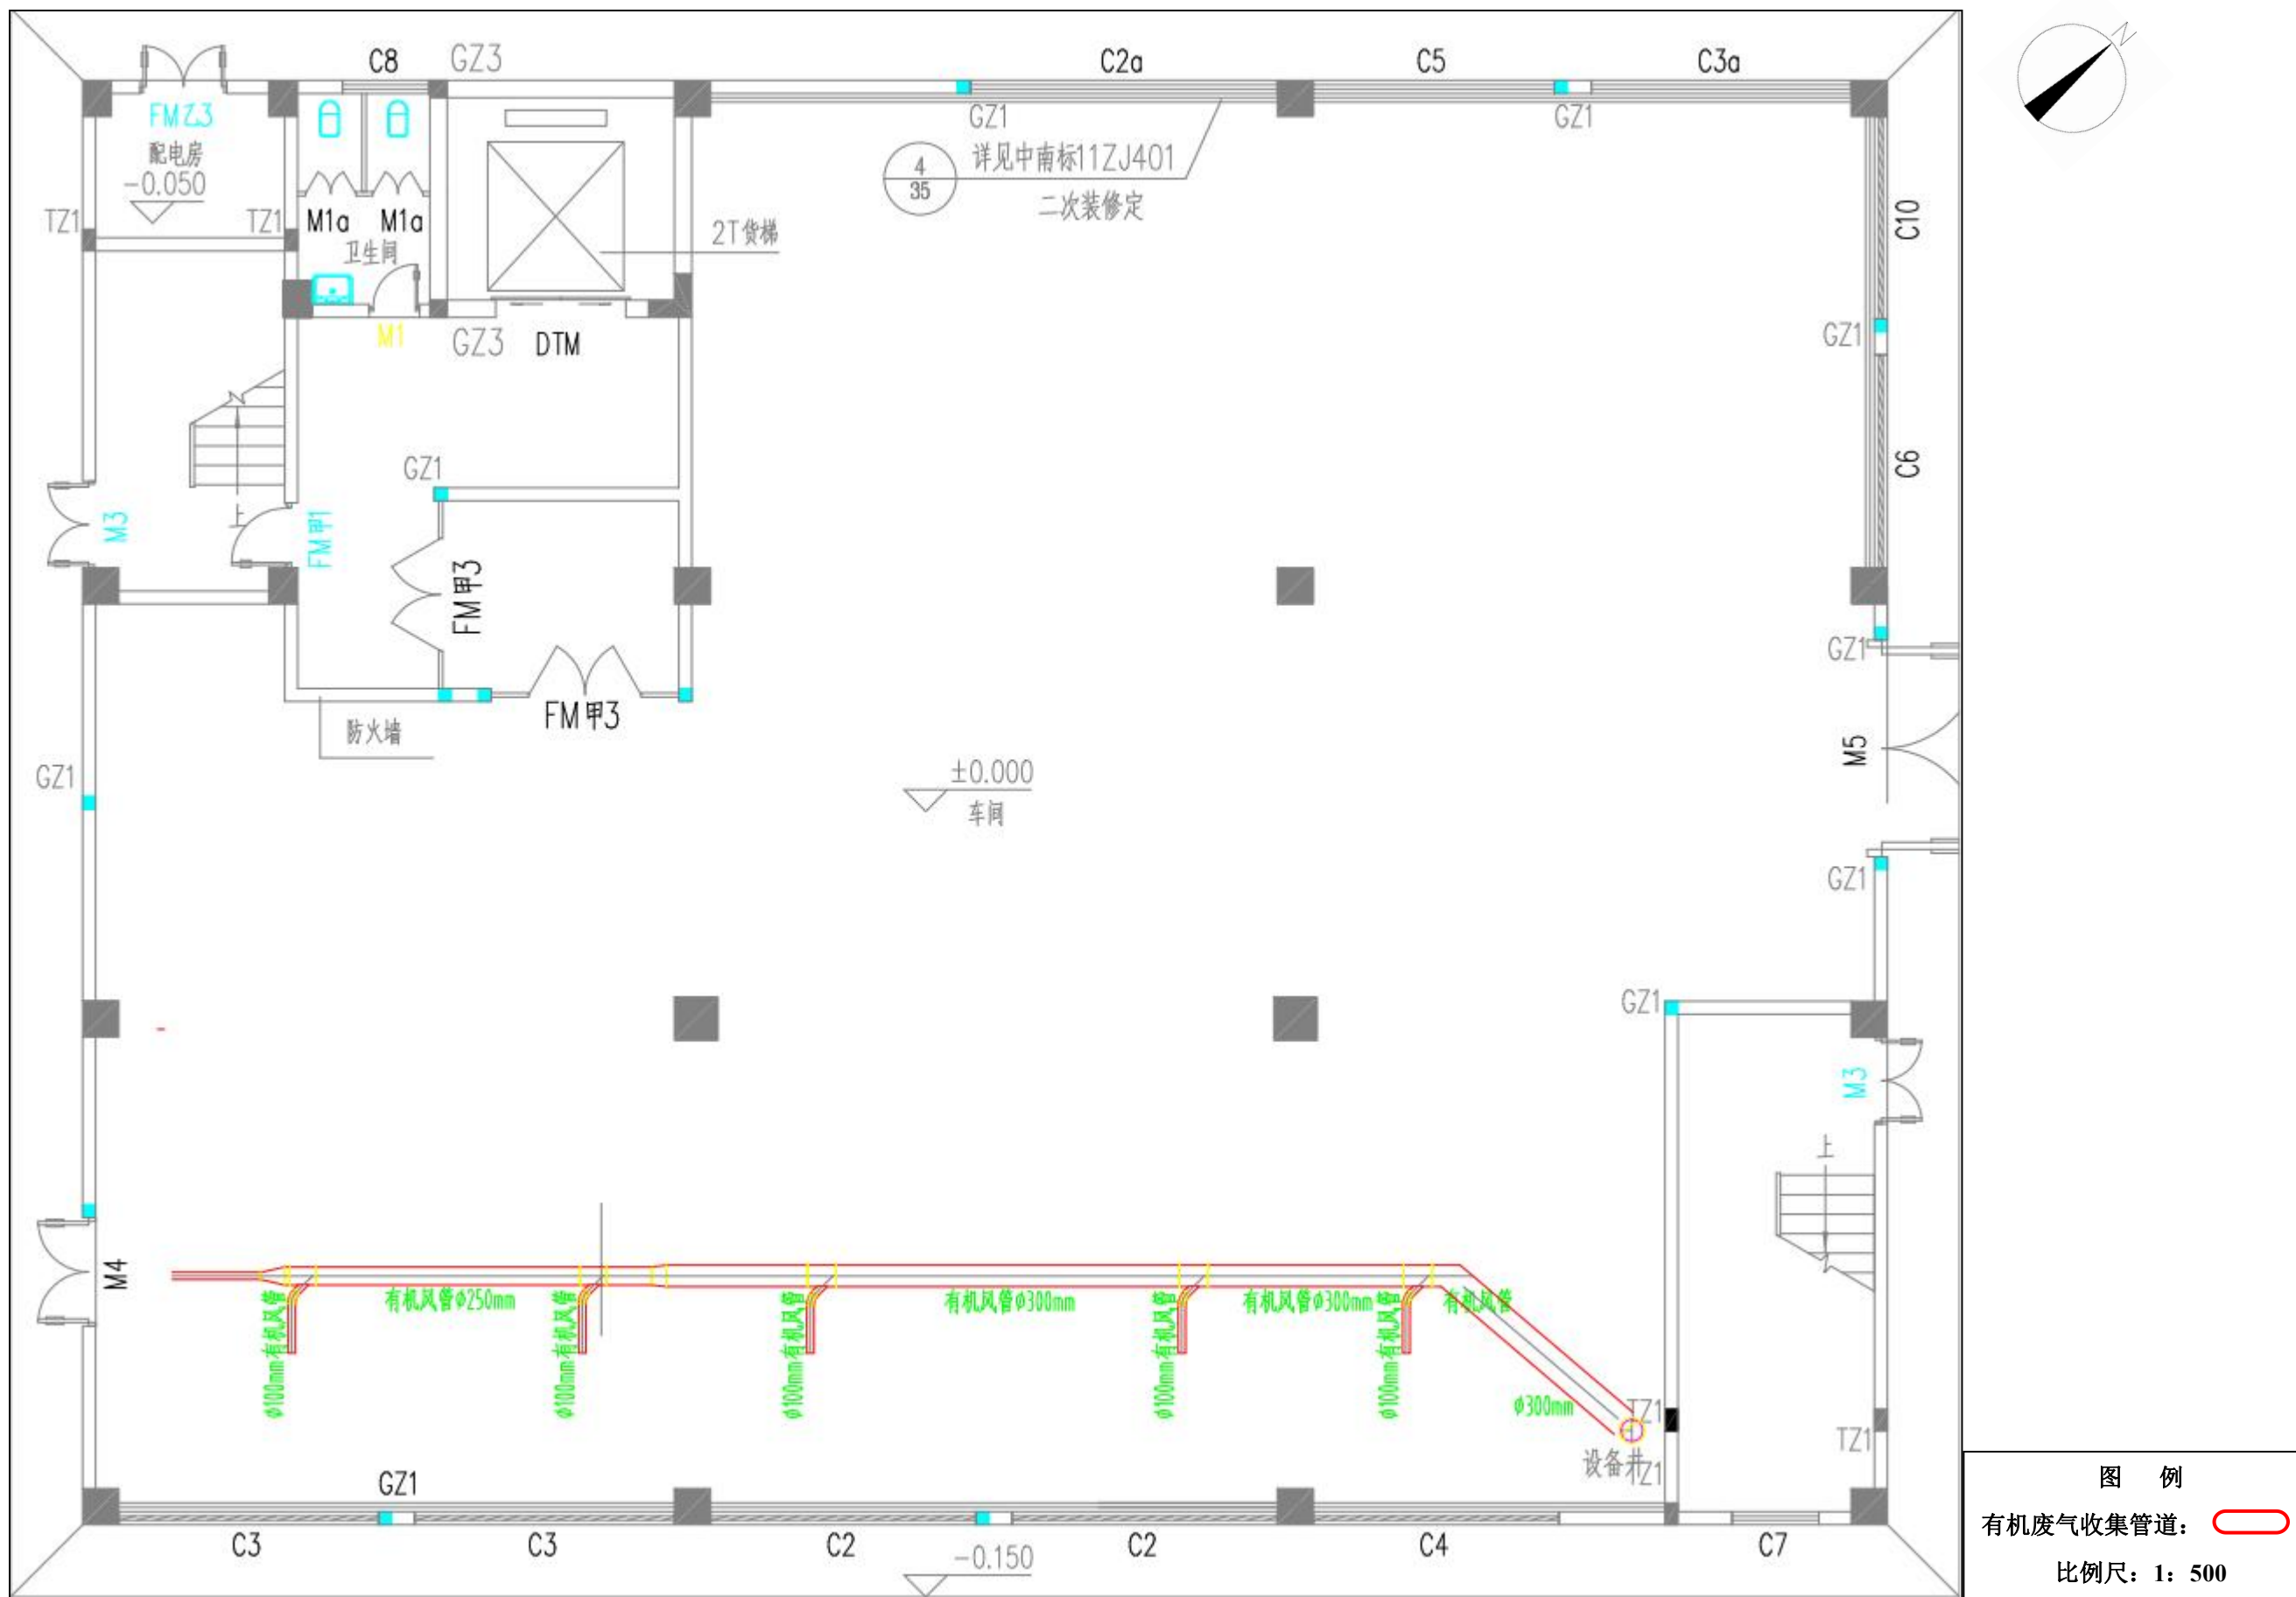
改扩建后，树脂生产线 1F 平面布置图
